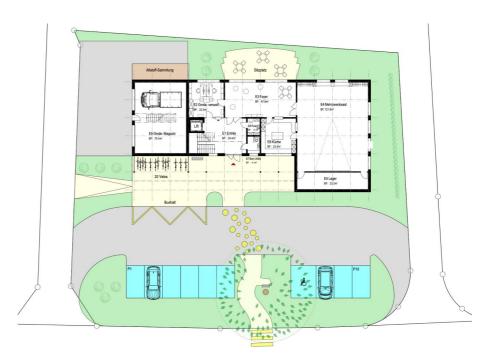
Situationsplan Bauvorhaben (Grundriss und Aussenraum)
